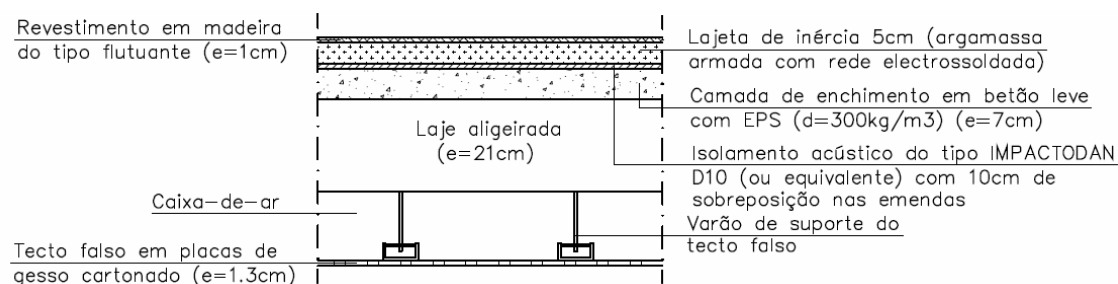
Pormenor construtivo da laje de piso intermédio - Pavi1
